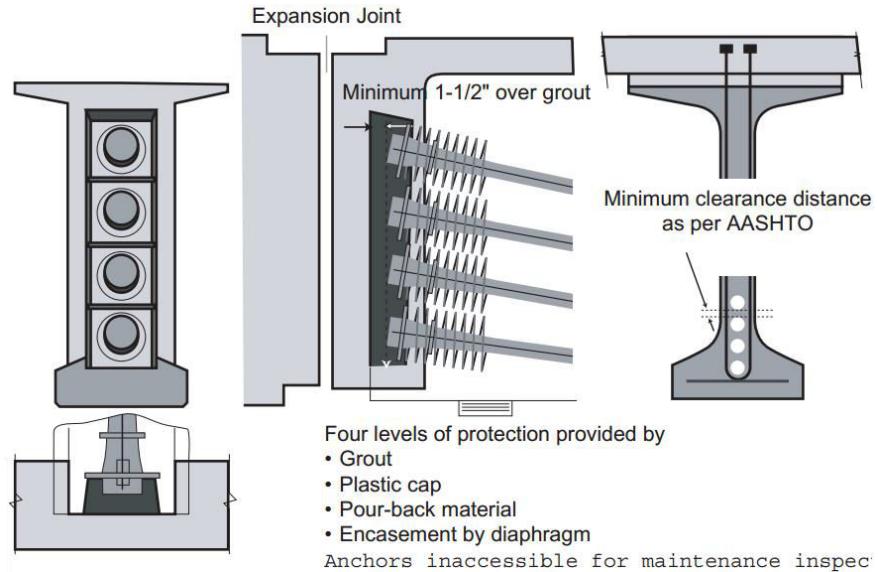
Detalles de protección del anclaje en los anclajes extremos.
